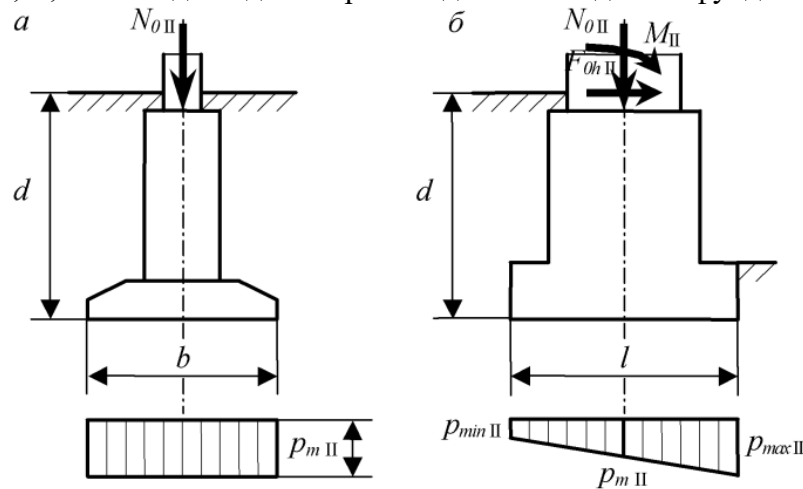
Розрахункові схеми та епюри тисків під підшовою (контактних тисків) для різних випадків навантаження фундаментів: а – центральне навантаження; б - позацентрове навантаження
